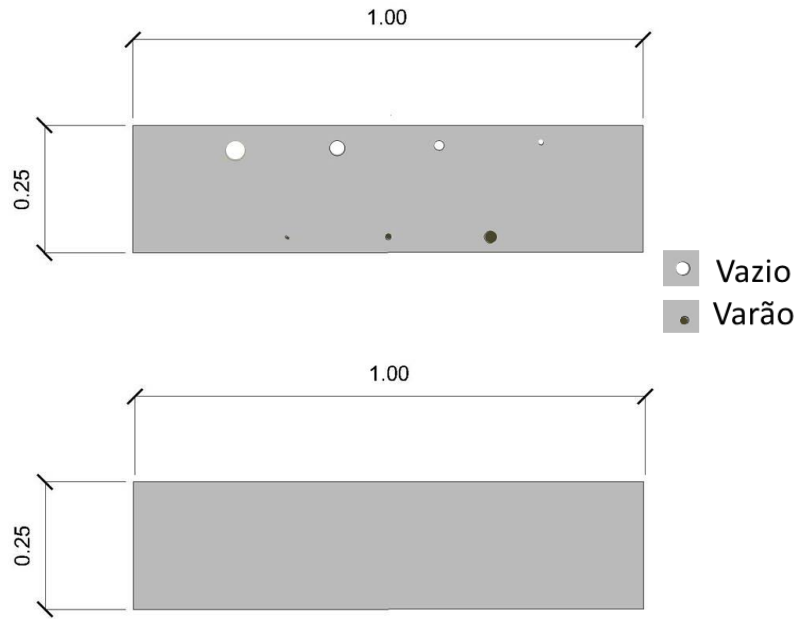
Plantas da Viga A e da Viga B (dimensões em m)
